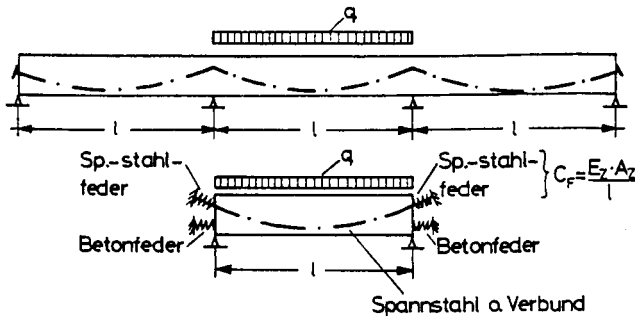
Einfeldträger mit Beton- und Spannstahlfedern, aus [3]
